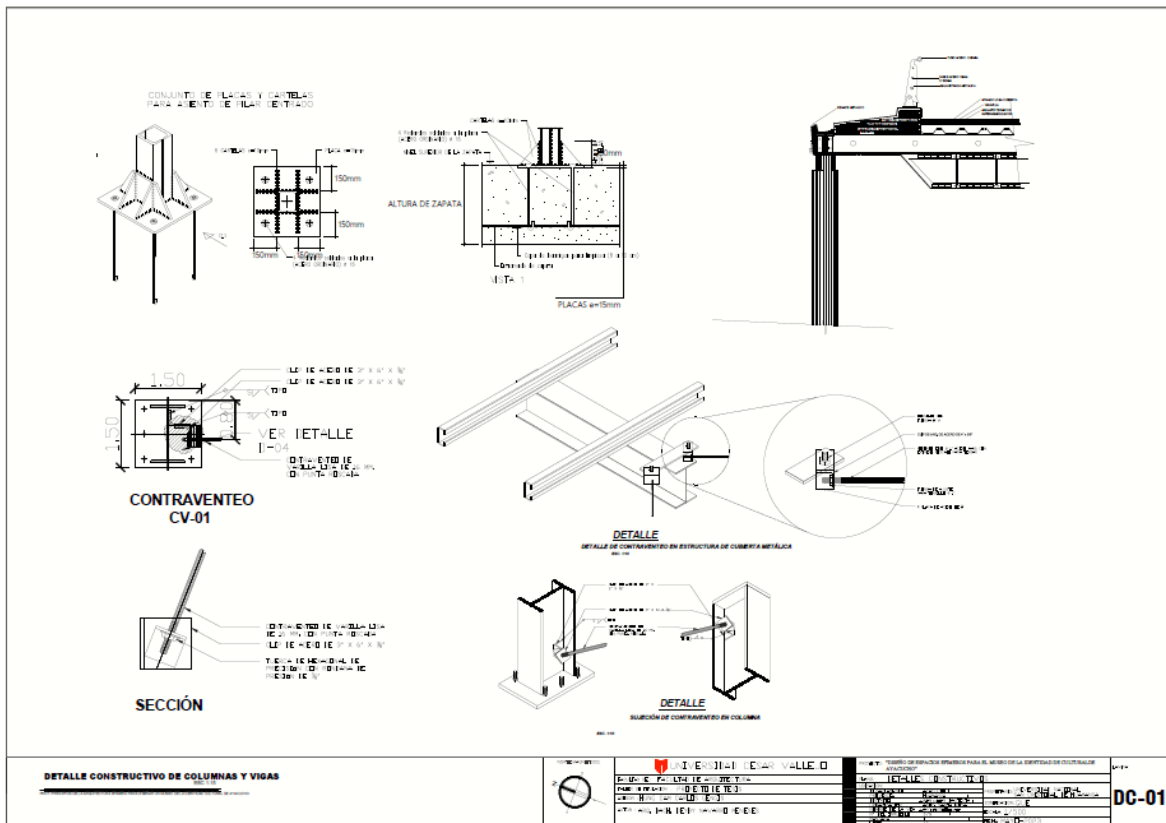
Detalles Constructivos estructura Vigas, Columnas y losa colaborante
